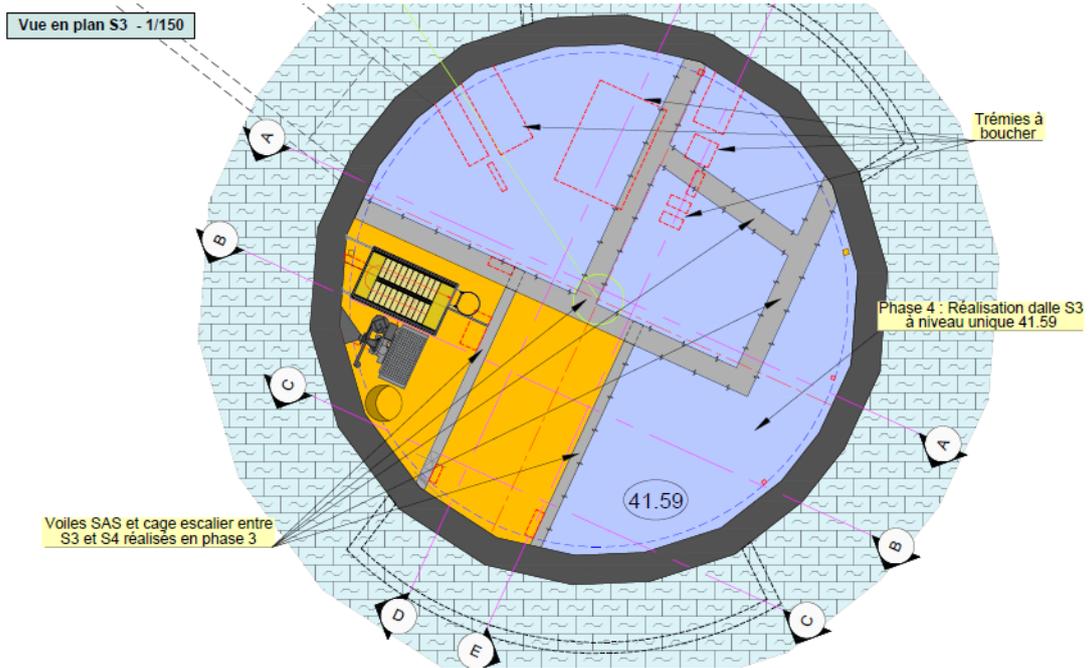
Vue en plan - Dalle S3 (épaisseur 50cm) en un seul niveau
